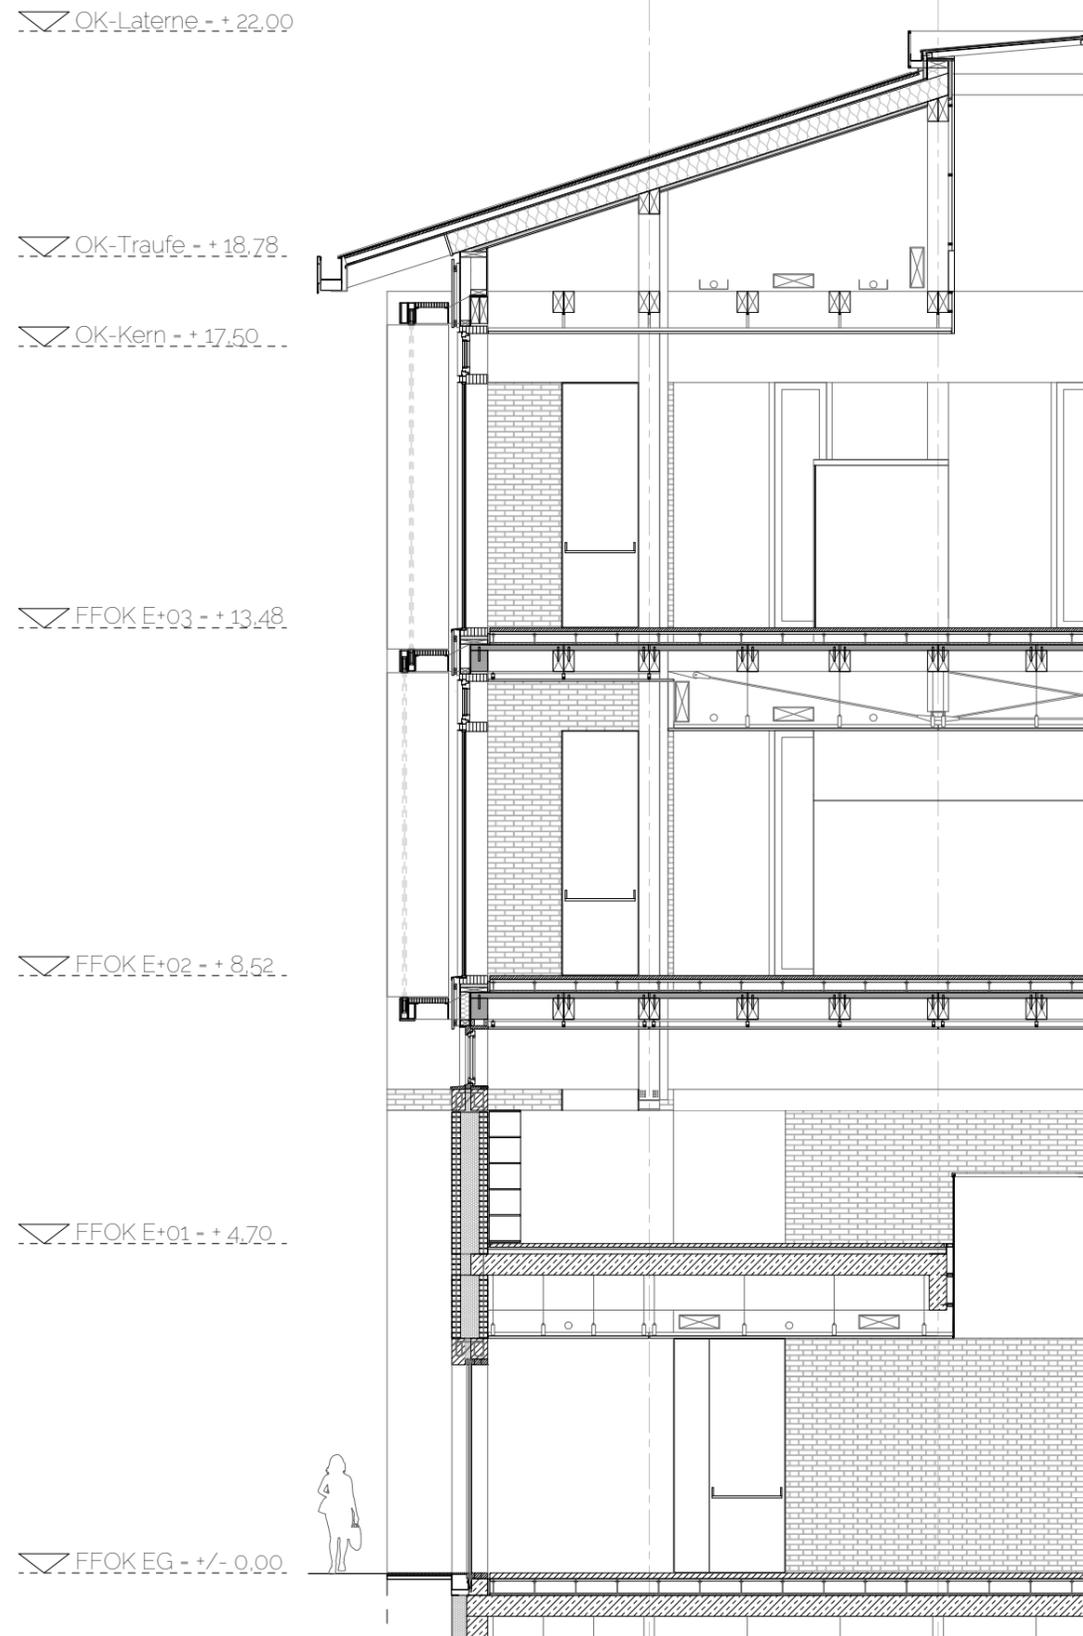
Systemdarstellung - Fassade mit Sonnenschutz - Faltelementen
